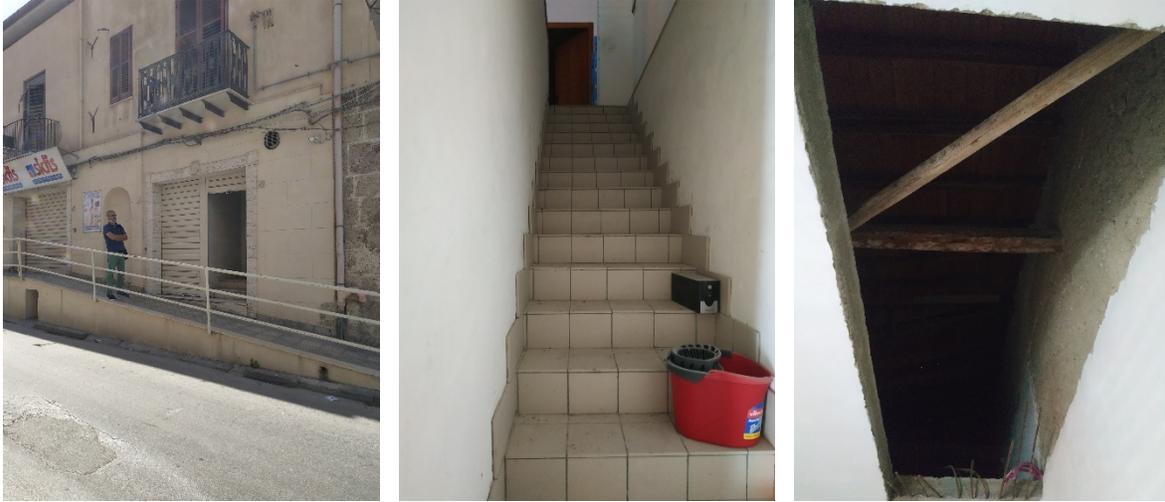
A sinistra vano di accesso al piano primo, al centro il vano scala ed a sinistra botola per accesso al sottotetto
